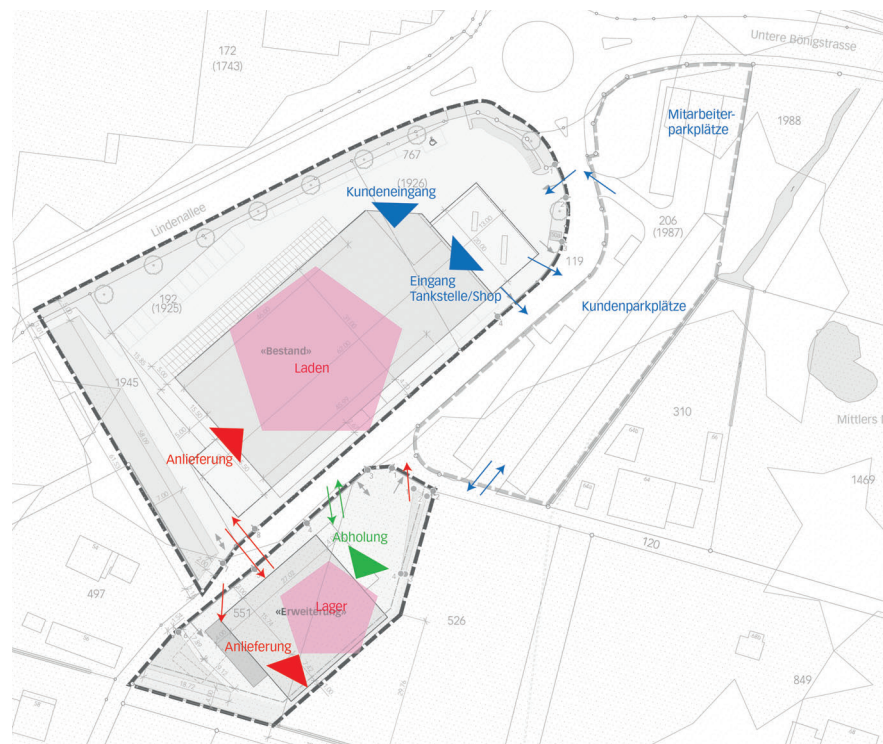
Erschliessungsschema mit Erweiterungsareal
